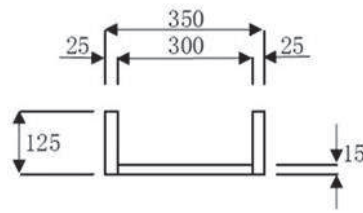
(3) 主桁 (4 桁) の断面形状 (単位 : mm)
